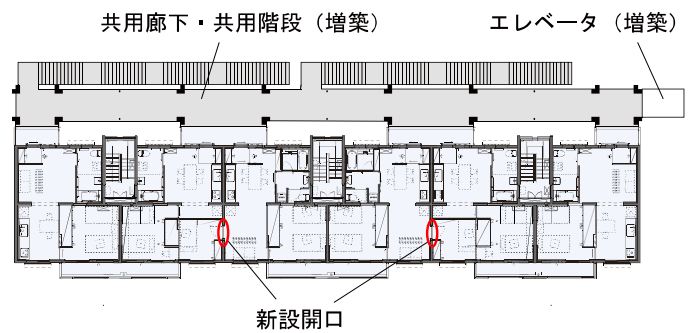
WPC 構造住宅の大規模改修モデル計画の一般階平面図
